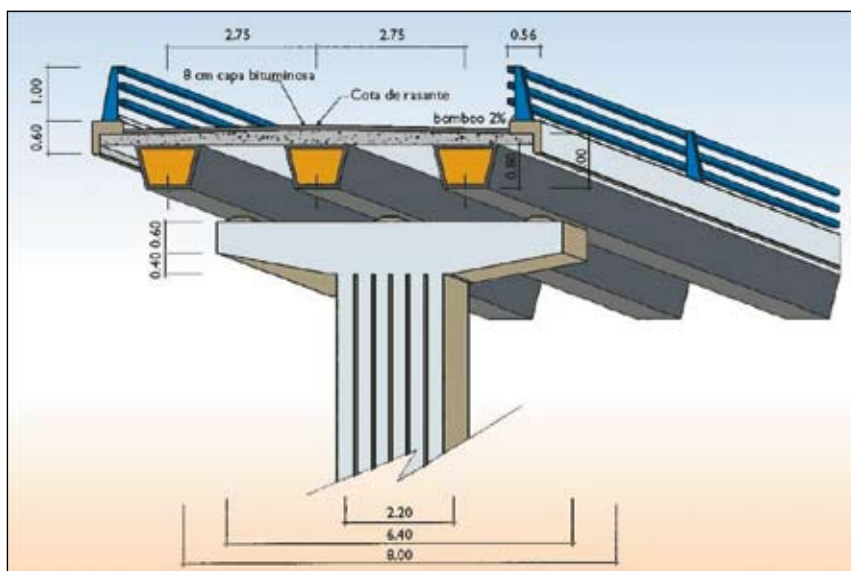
Puente sobre la Autovía del Cantábrico. Sección transversal.
